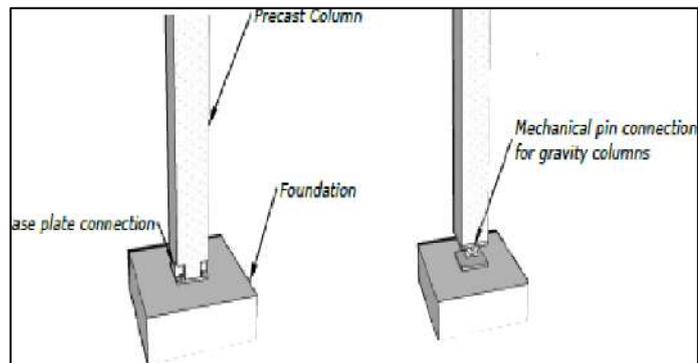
Assemblage fondation. Source : PRE-ENGINEERED RI III DING-pdf
